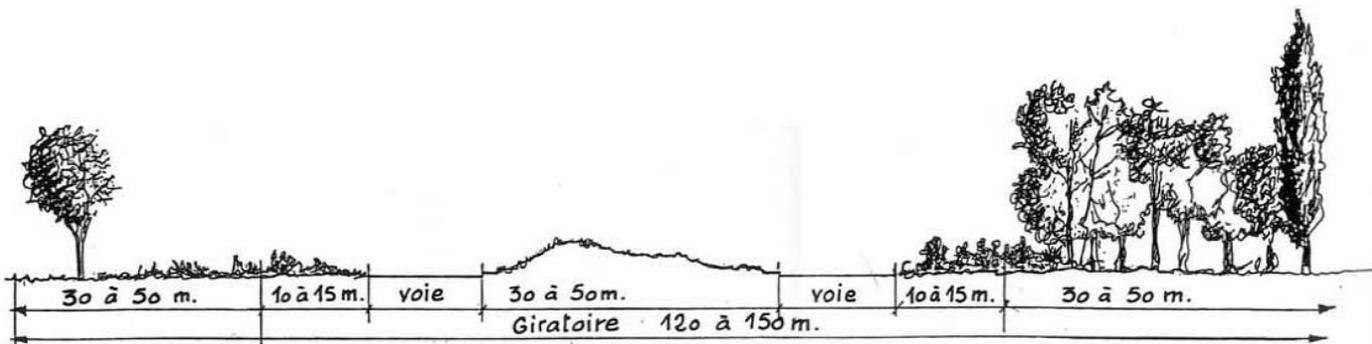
Coupe de principe d'un carrefour d'entrée d'une zone d'activités
